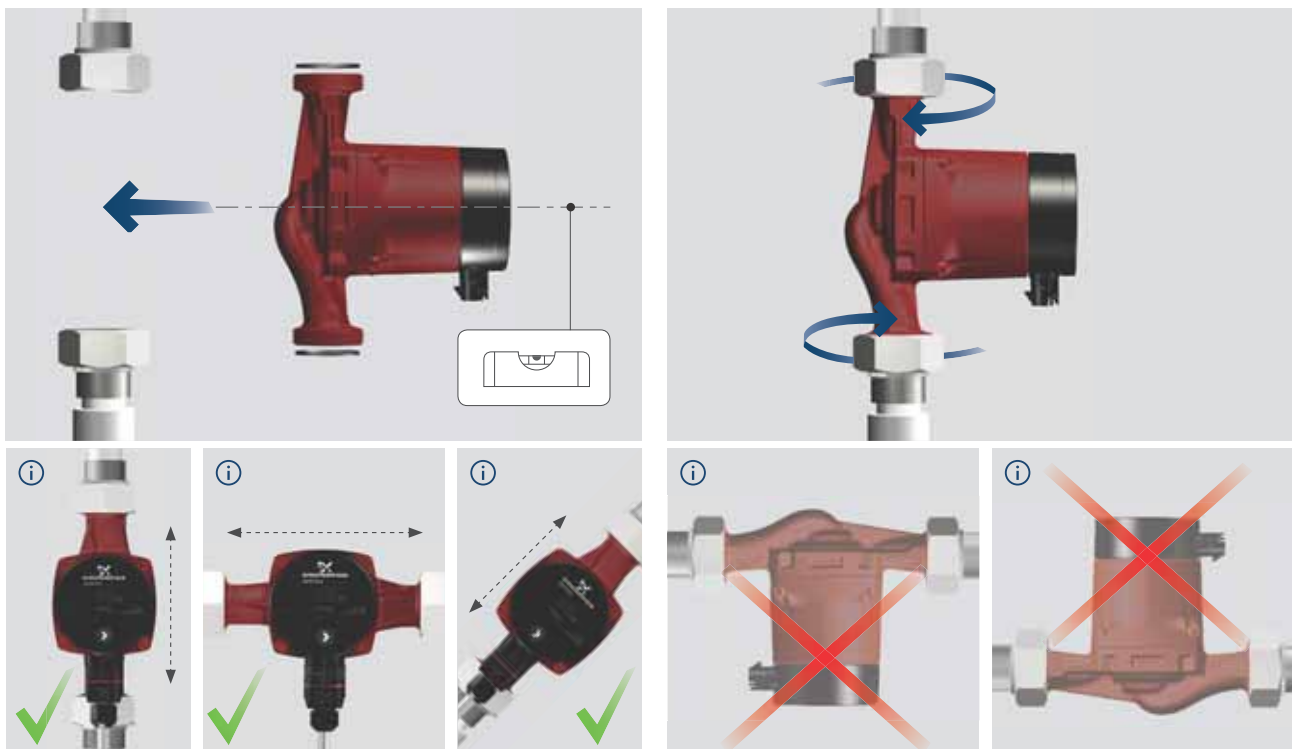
Montaje de la bomba GRUNDFOS ALPHA1
